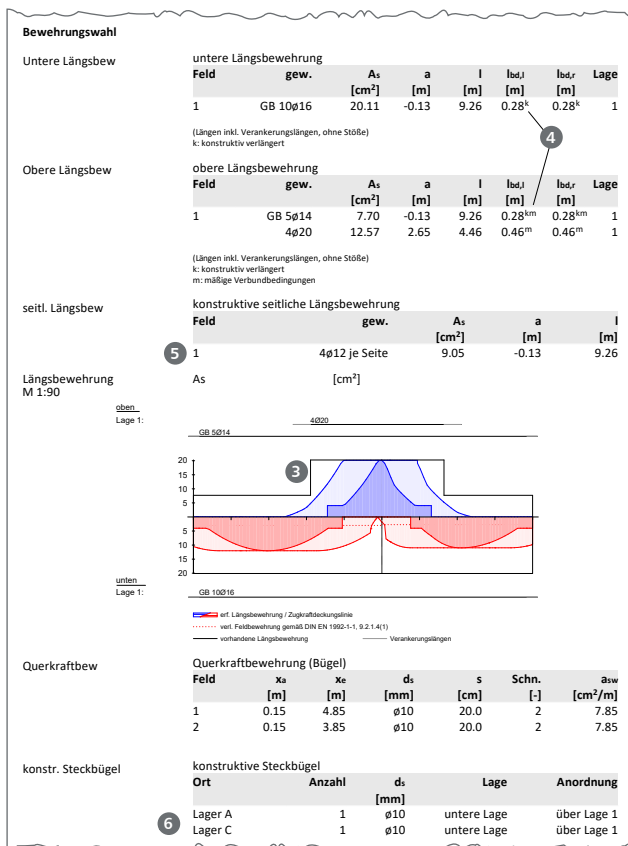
Ausgabe – Bewehrungswahl (S340.de)
